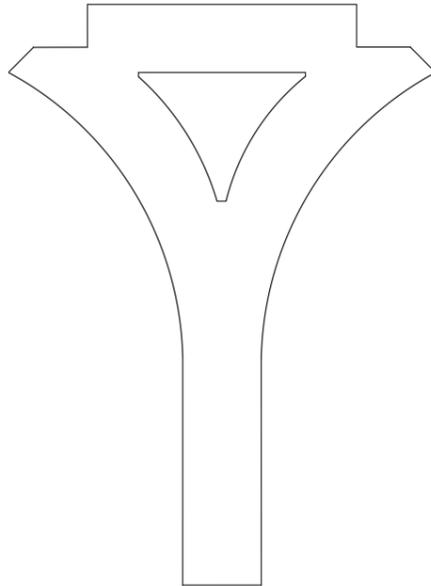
Pila número 4. (Fuente: elaboración propia en AutoCAD).
